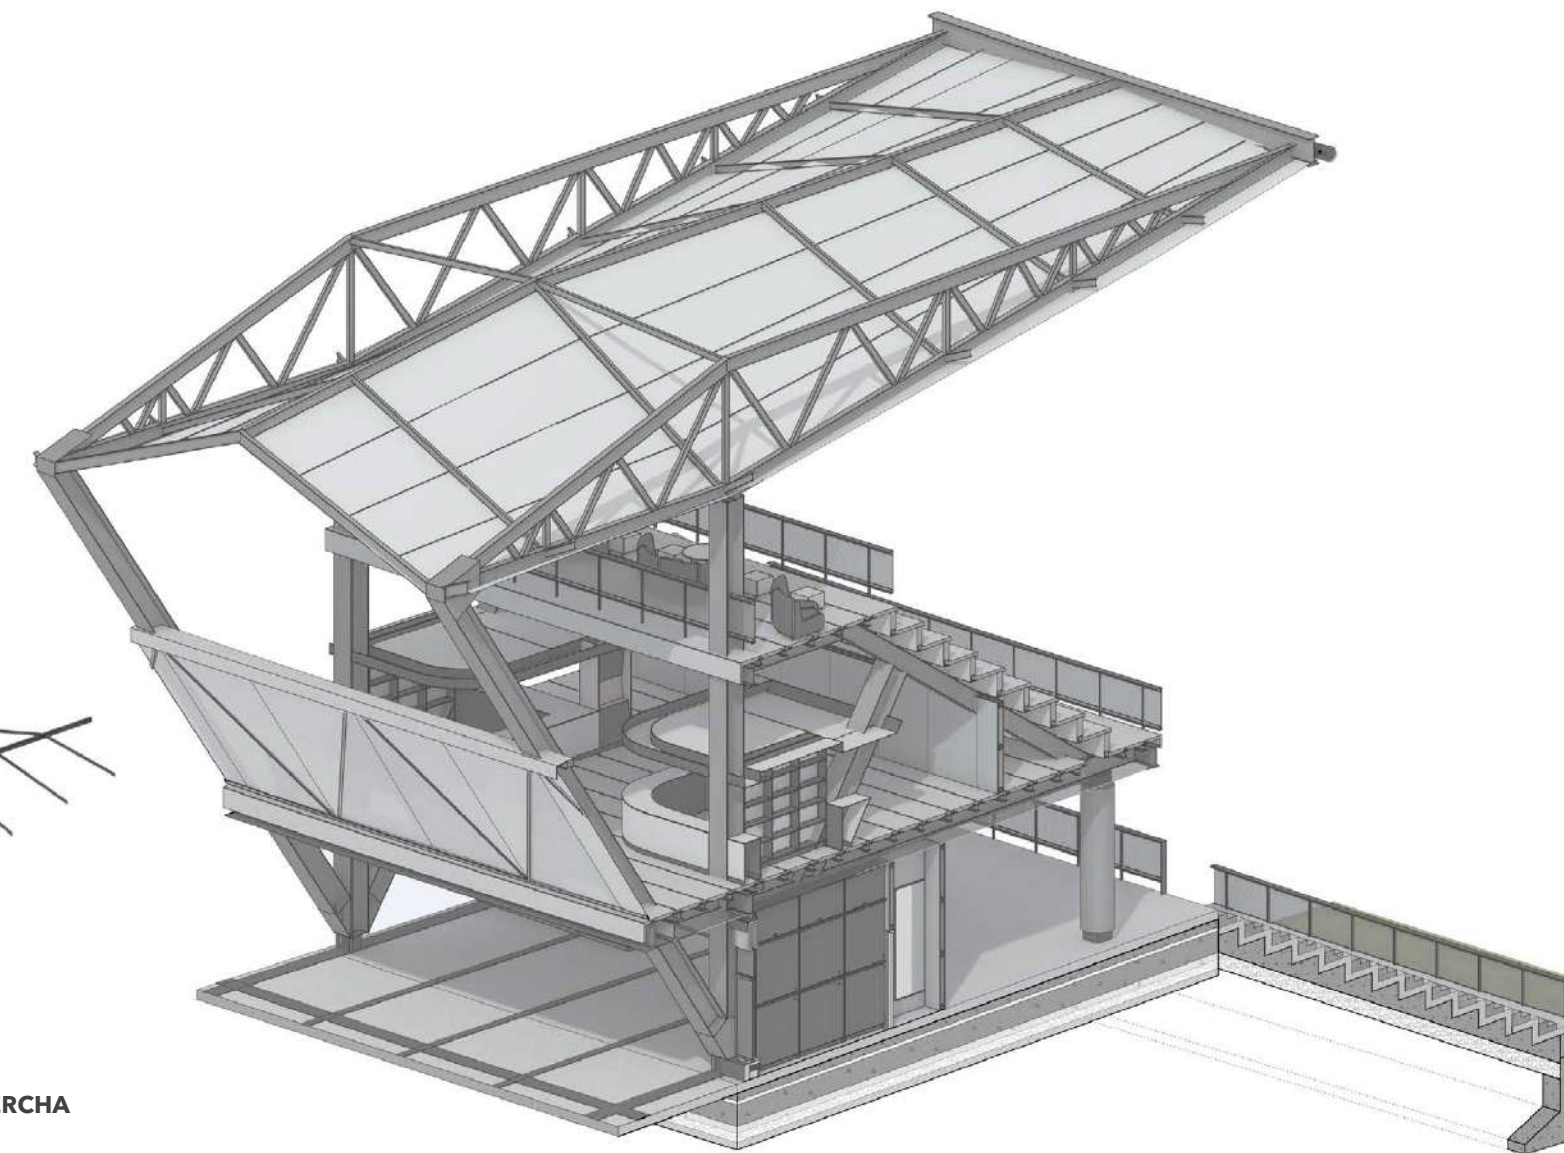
Anclaje cubierta Fuente: Elaboración propia
